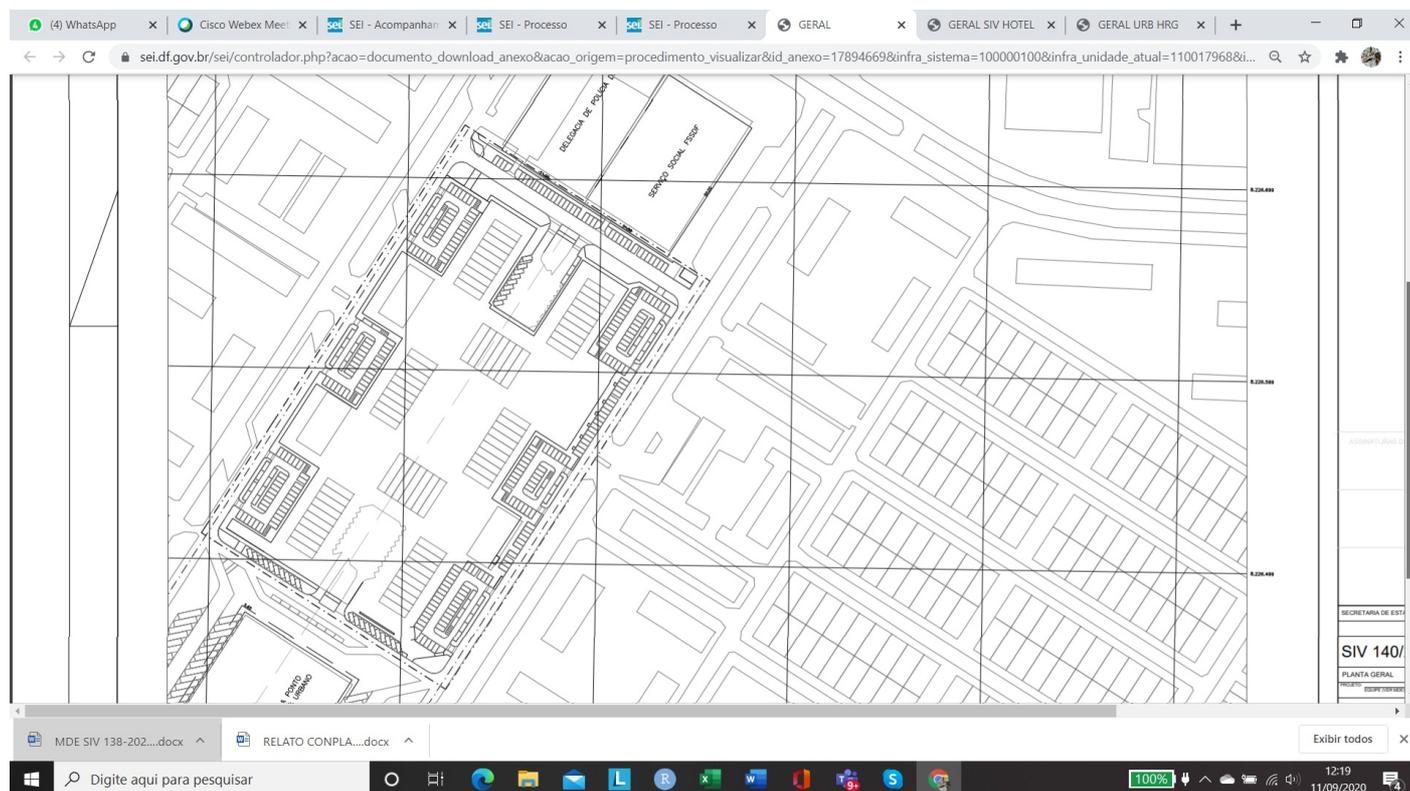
Planta do Projeto de sistema viário e paisagismo do Comercio Central do Gama - SIV 140/2020
